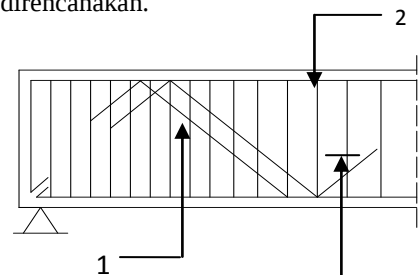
Jenis pemasangan tulangan longitudinal pada balok
